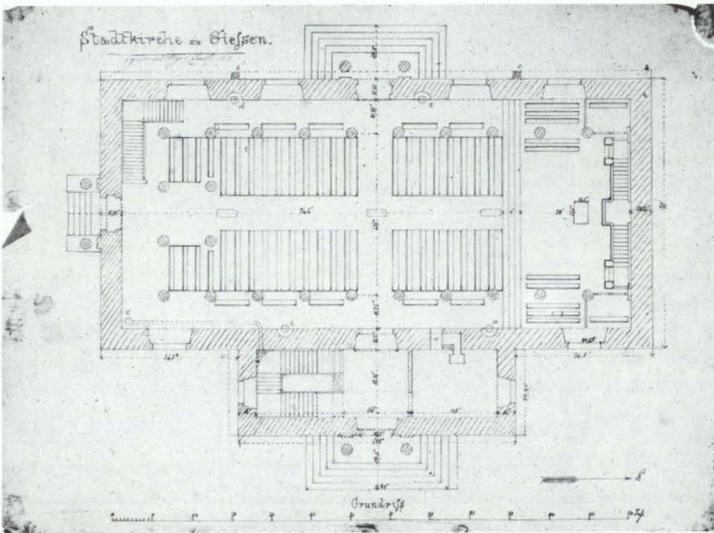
Entwurf für den Moller-Bau, Grundriß, Federzeichnung auf Transparentpapier 455 : 360 mm, Hochbauamt
